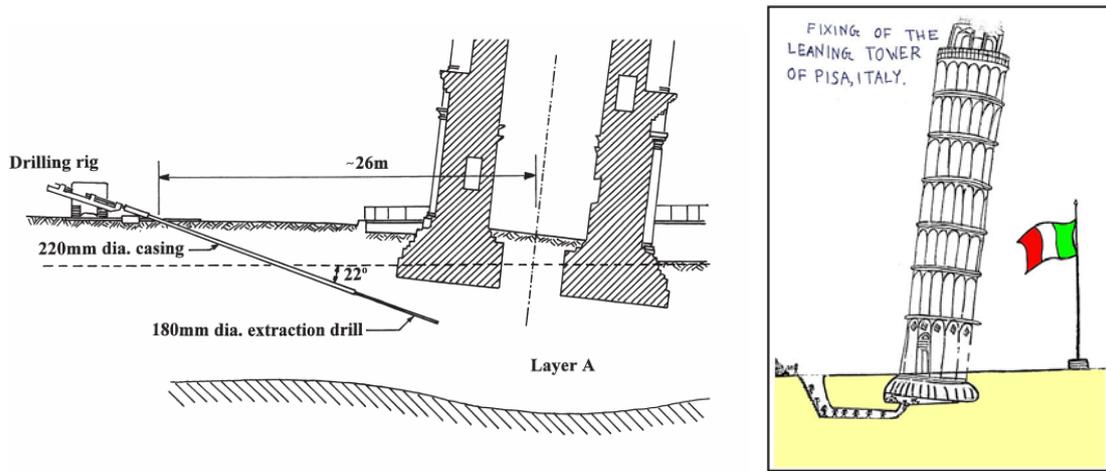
Estabilización de la Torre de Pisa mediante extracción controlada de terreno (izquierda) y solución propuesta por Chumki Bhaban de 9 años (derecha)
